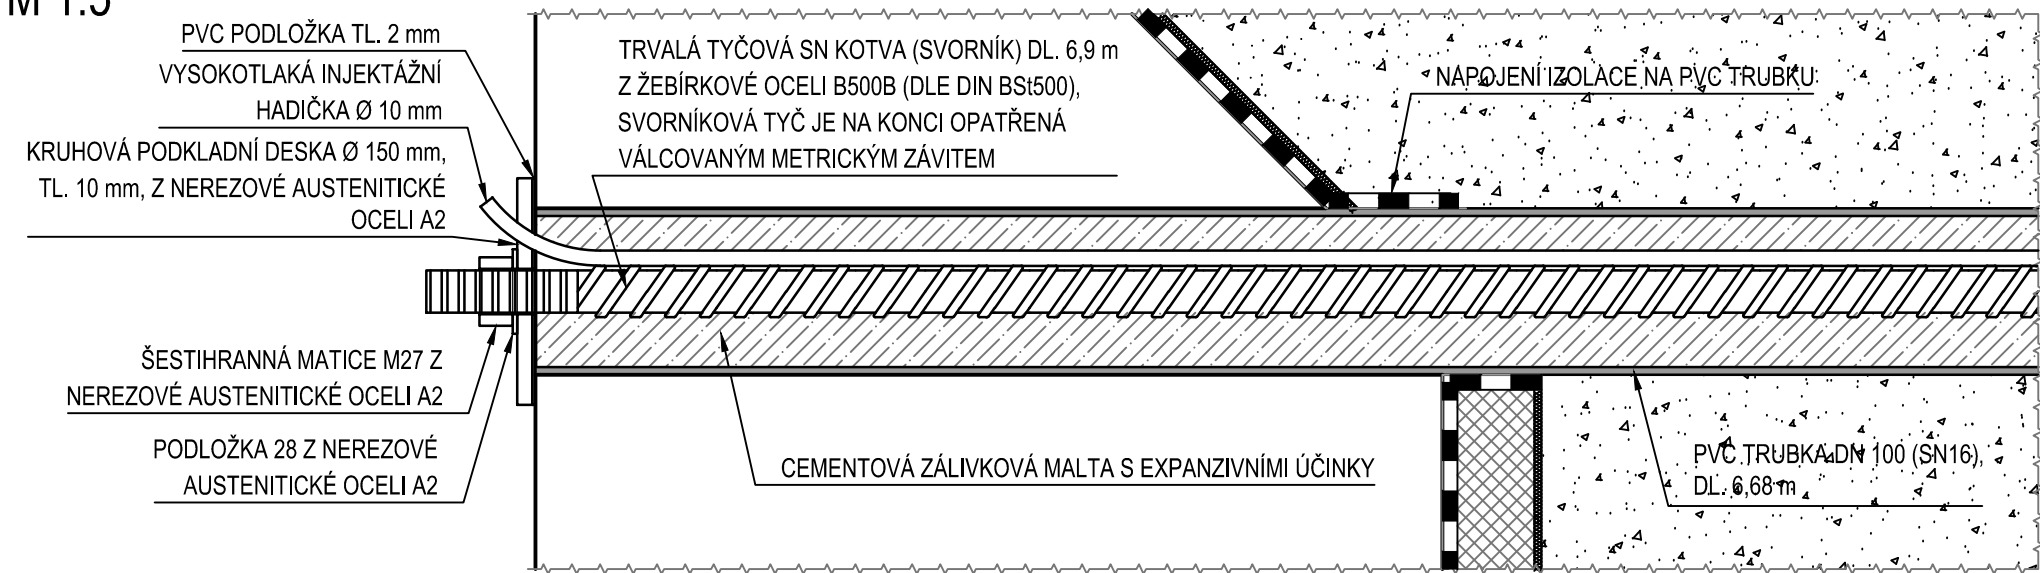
DETAIL TYČOVÉ KOTVY S OBETONOVÁNÍM
